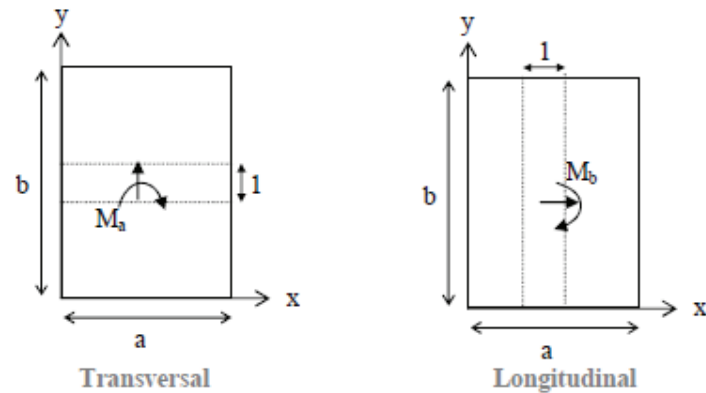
Moment transversale et longitudinale sur la dalle.
